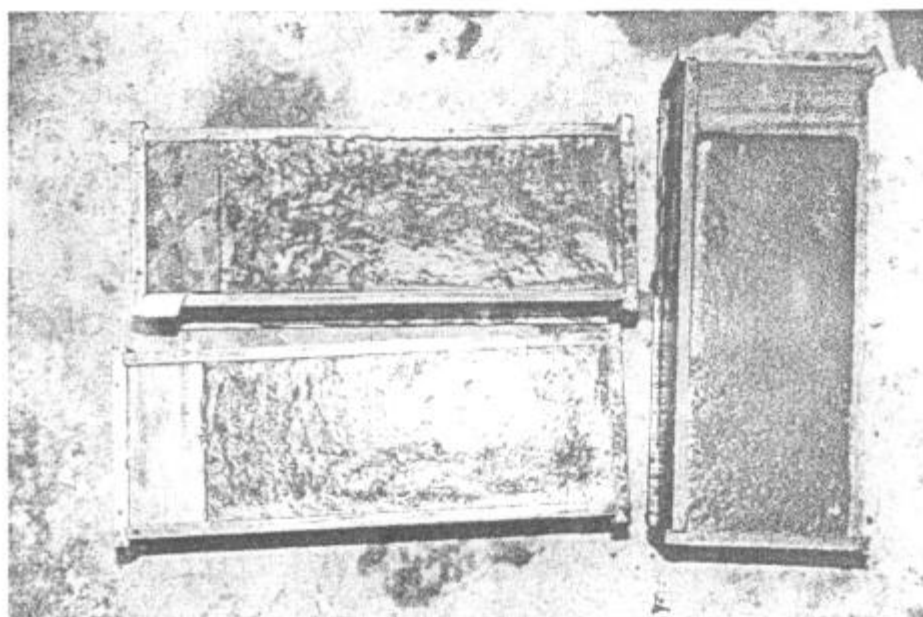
Colado del hormigón en el molde. El hormigón fue previamente tamizado.
